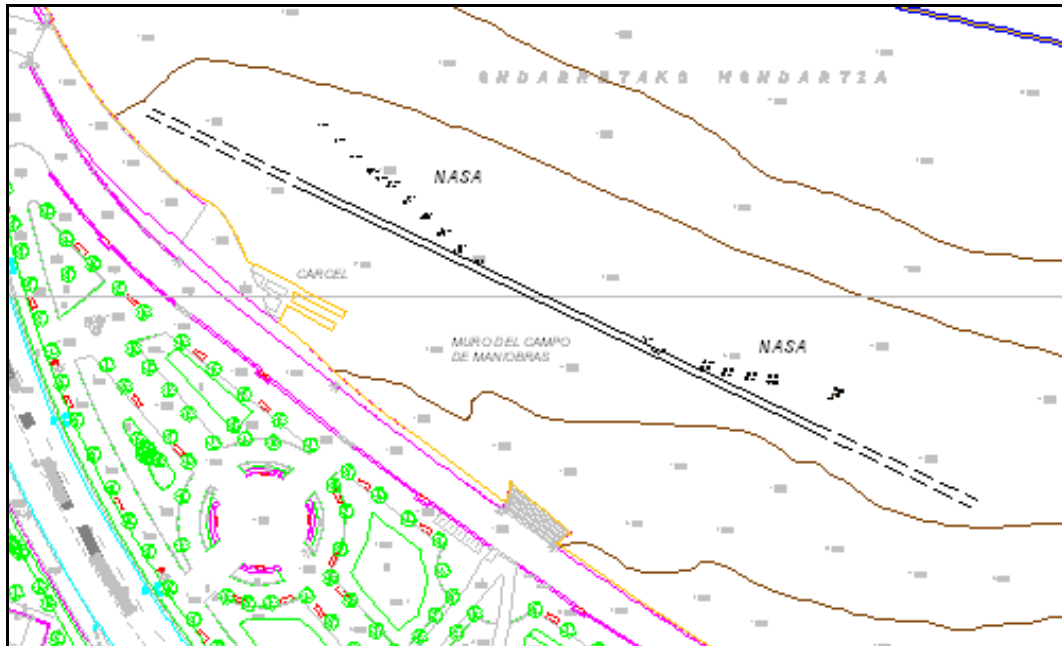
Planta de las estructuras (Alberdi, Pérez & Etxezarraga, 2005).
